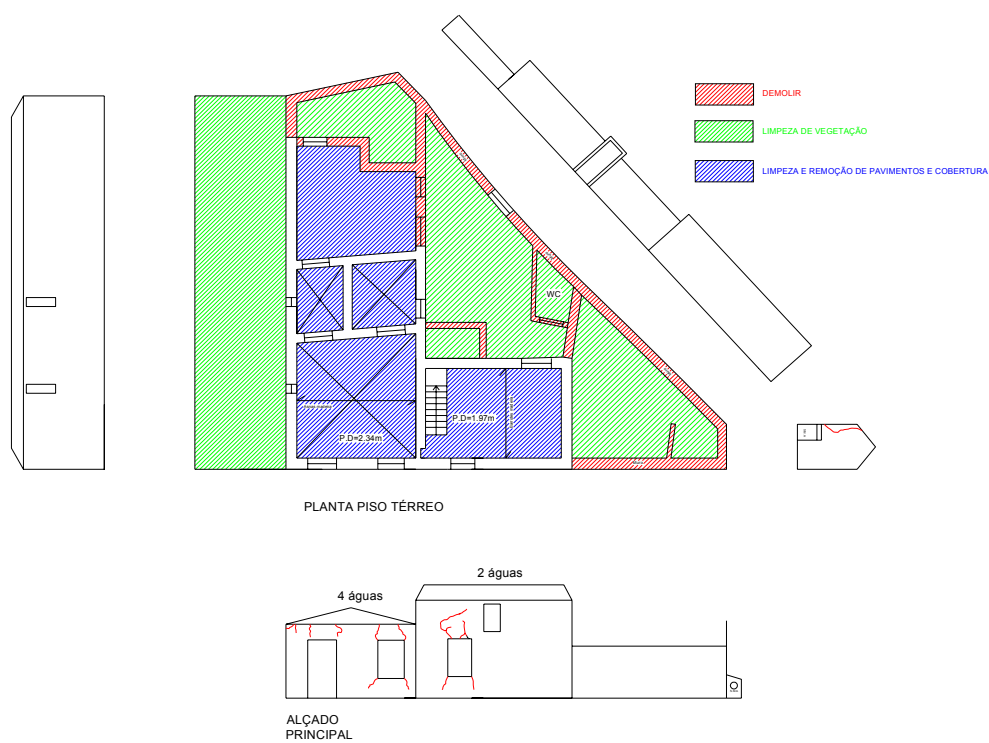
Registo geométrico da habitação e levantamento de fissuração importante
